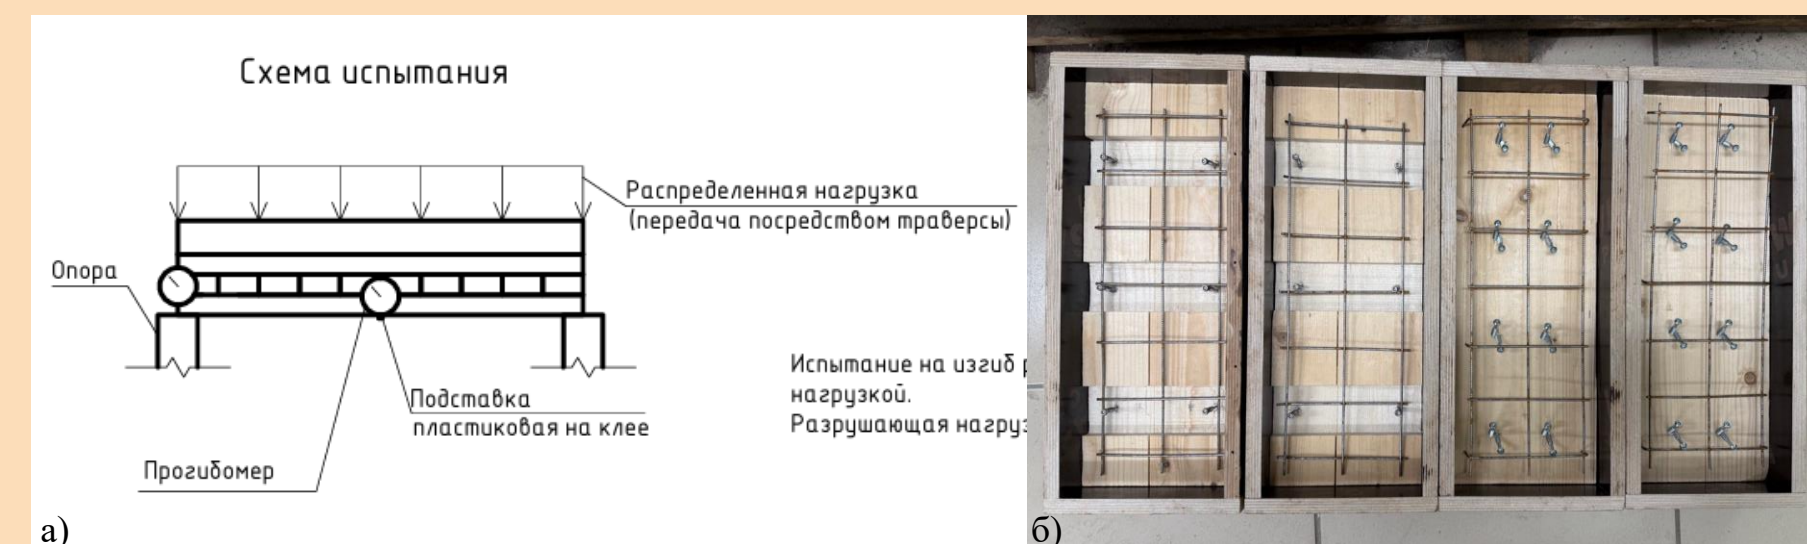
а) схема испытания; б) процесс подготовки образцов
